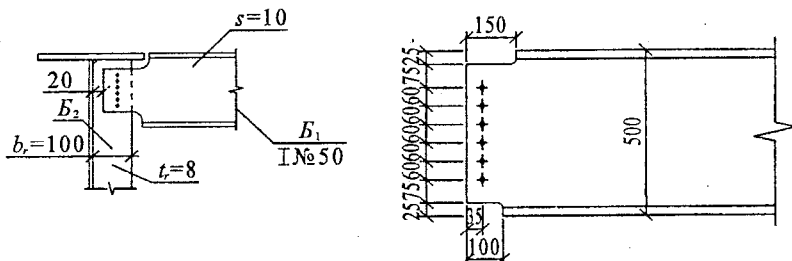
Схема конструювання болтового з'єднання балки B_1 до балки B_2
